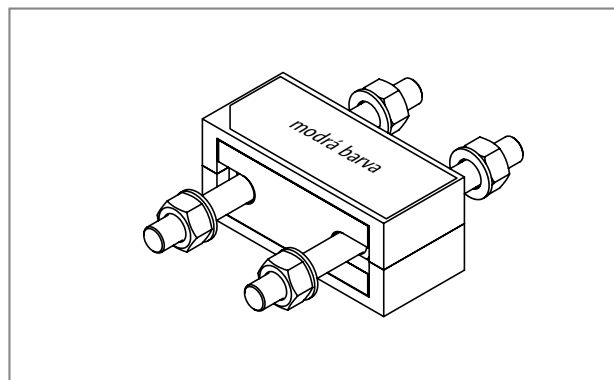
Schöck Isokorb® T typ S-V-D16: Pohled
